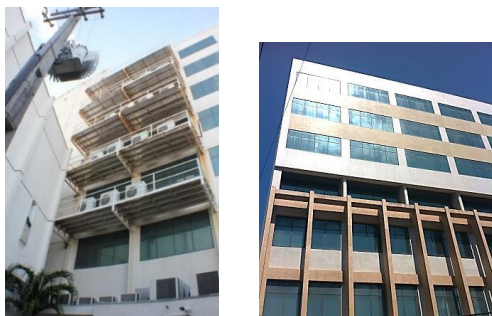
Detalhe da laje técnica metálica, Centro de Exportadores do Ceará.
